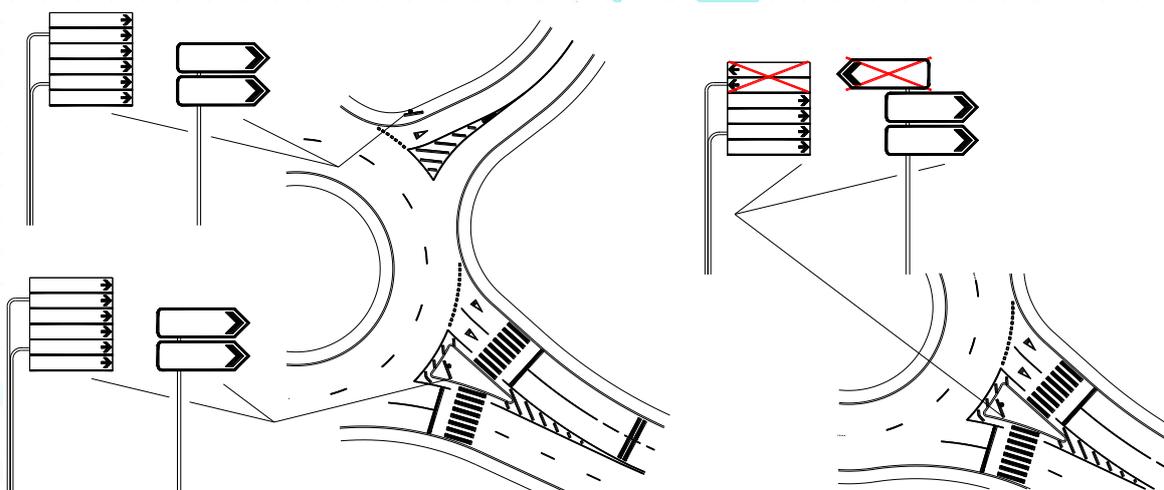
29 - Colocação de sinais direccionais em rotundas
